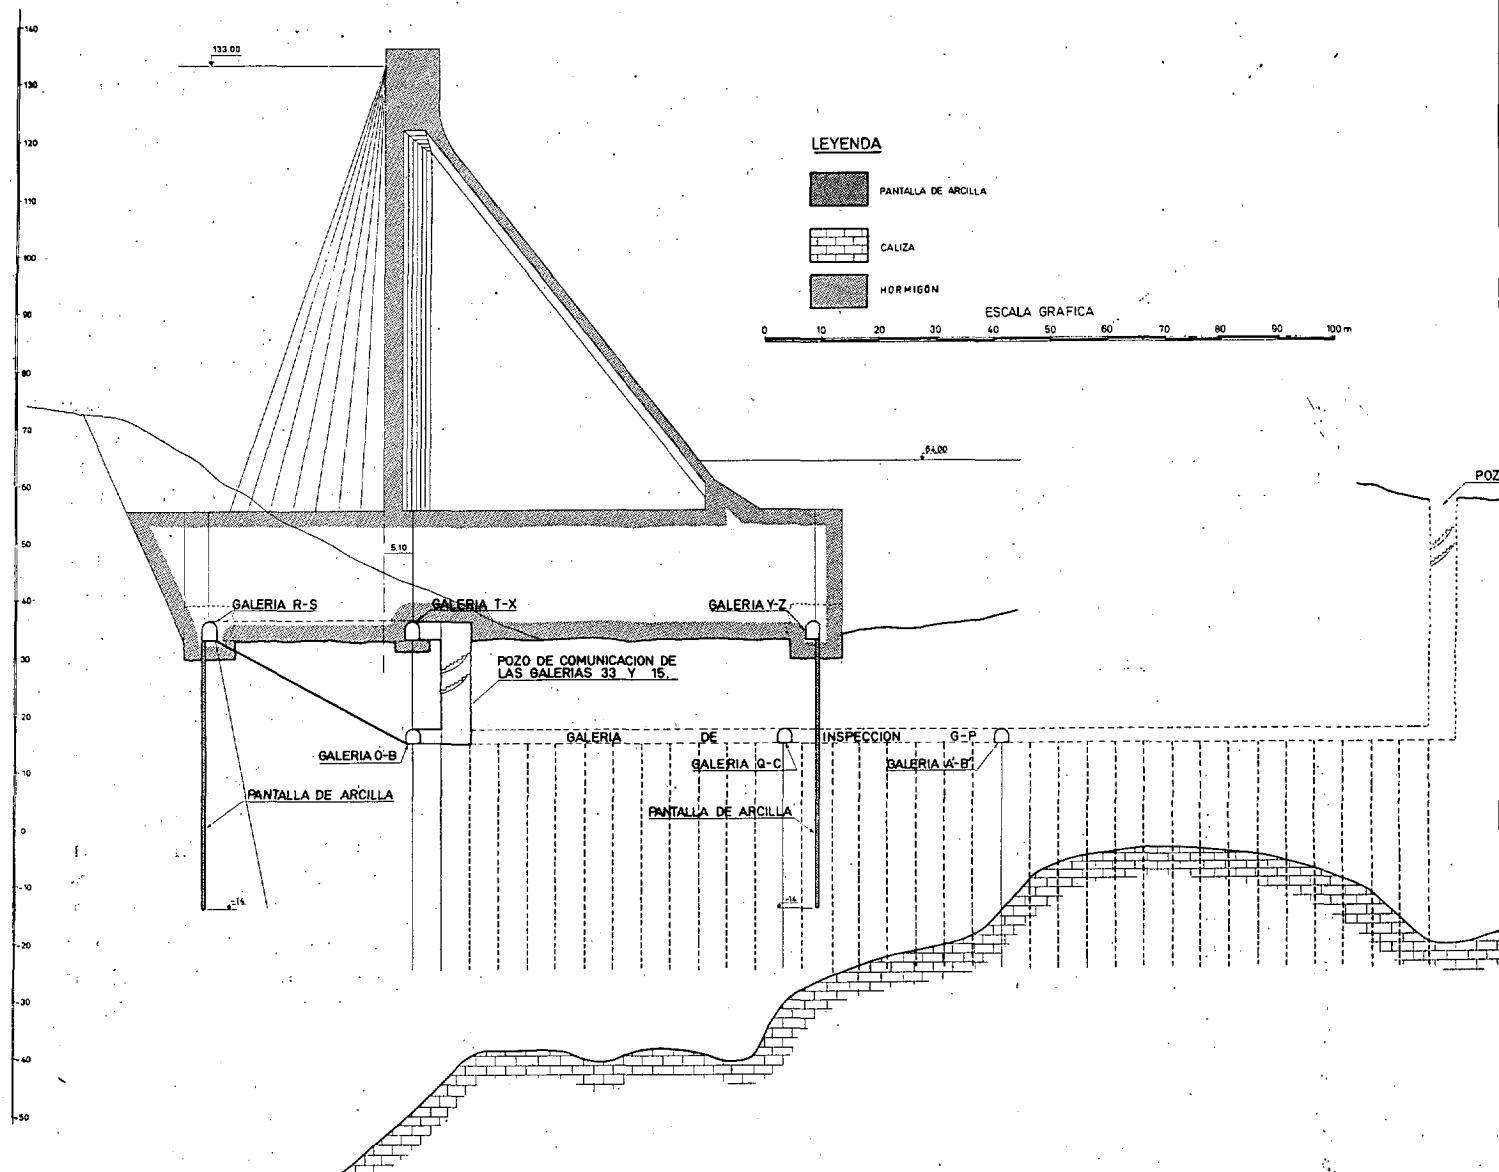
^a — Sistema de impermeabilización del terreno en el pantano de Tous, sección, alzado por el eje del perfil aligerado.
